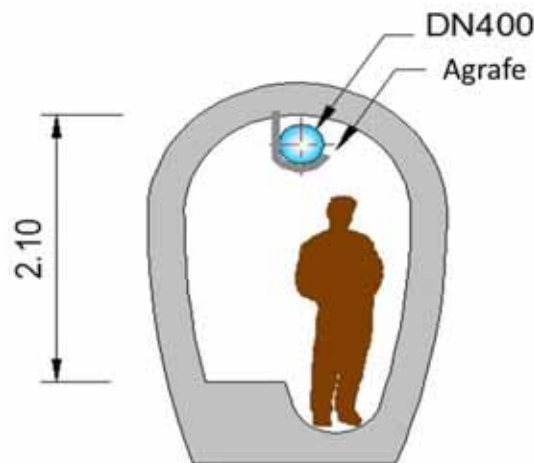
Hauteur minimale des réseaux assainissements pour la pose d'une conduite eaux usées traitées
